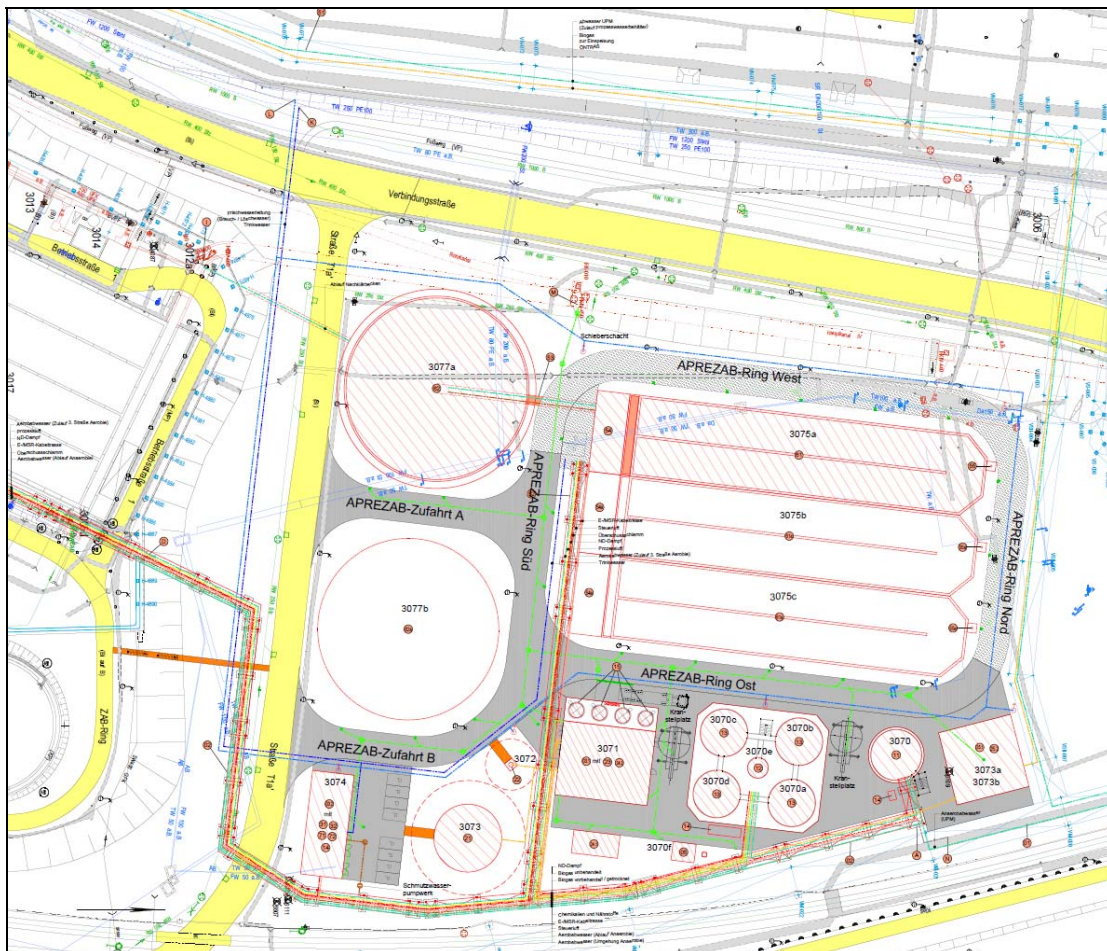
Lageplan der geplanten Abwasserbehandlungsanlage
